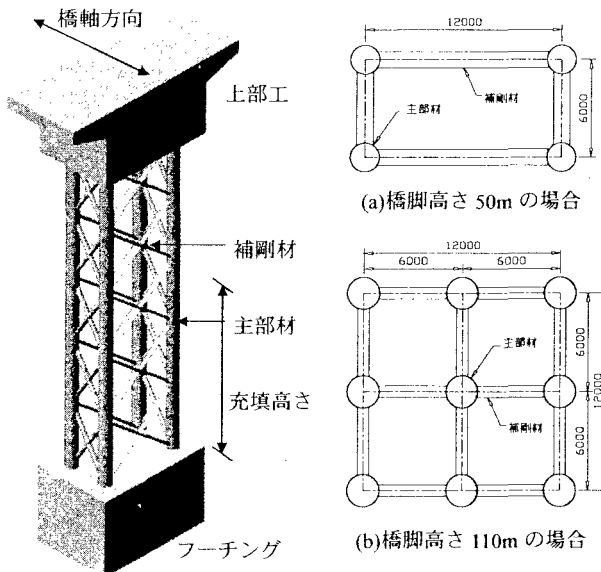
多柱式合成橋脚の概念図および断面図 (単位: mm)
